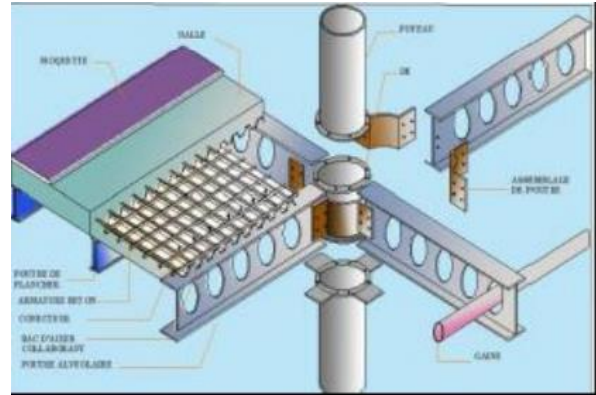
Détails de la combinaison d'une poutre alvéolaire
